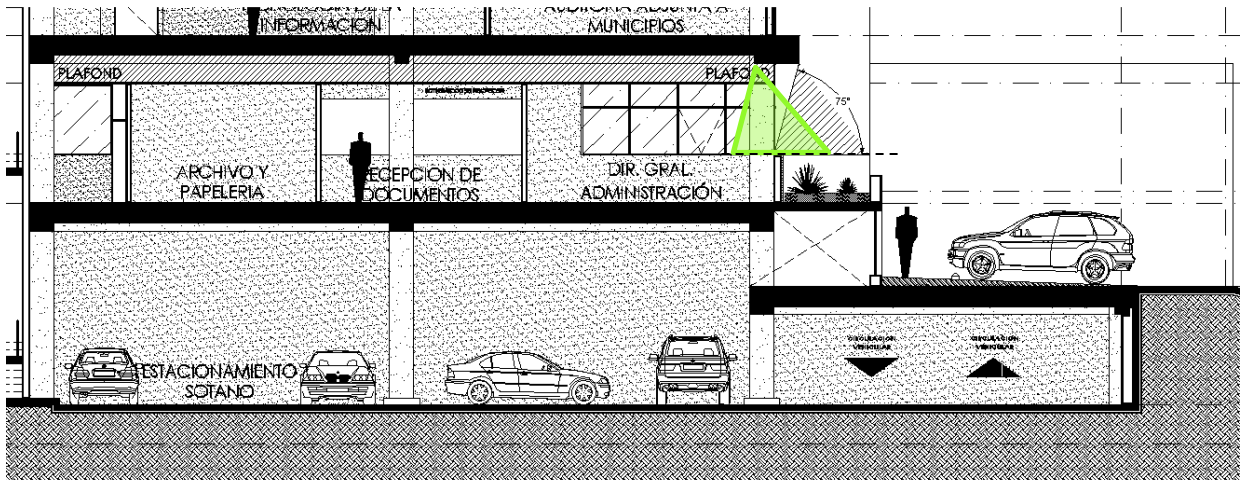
Representación en corte del ángulo de asoleamiento en Fachada Norte (Primer Nivel). Autoría: Lesley Esquer.
